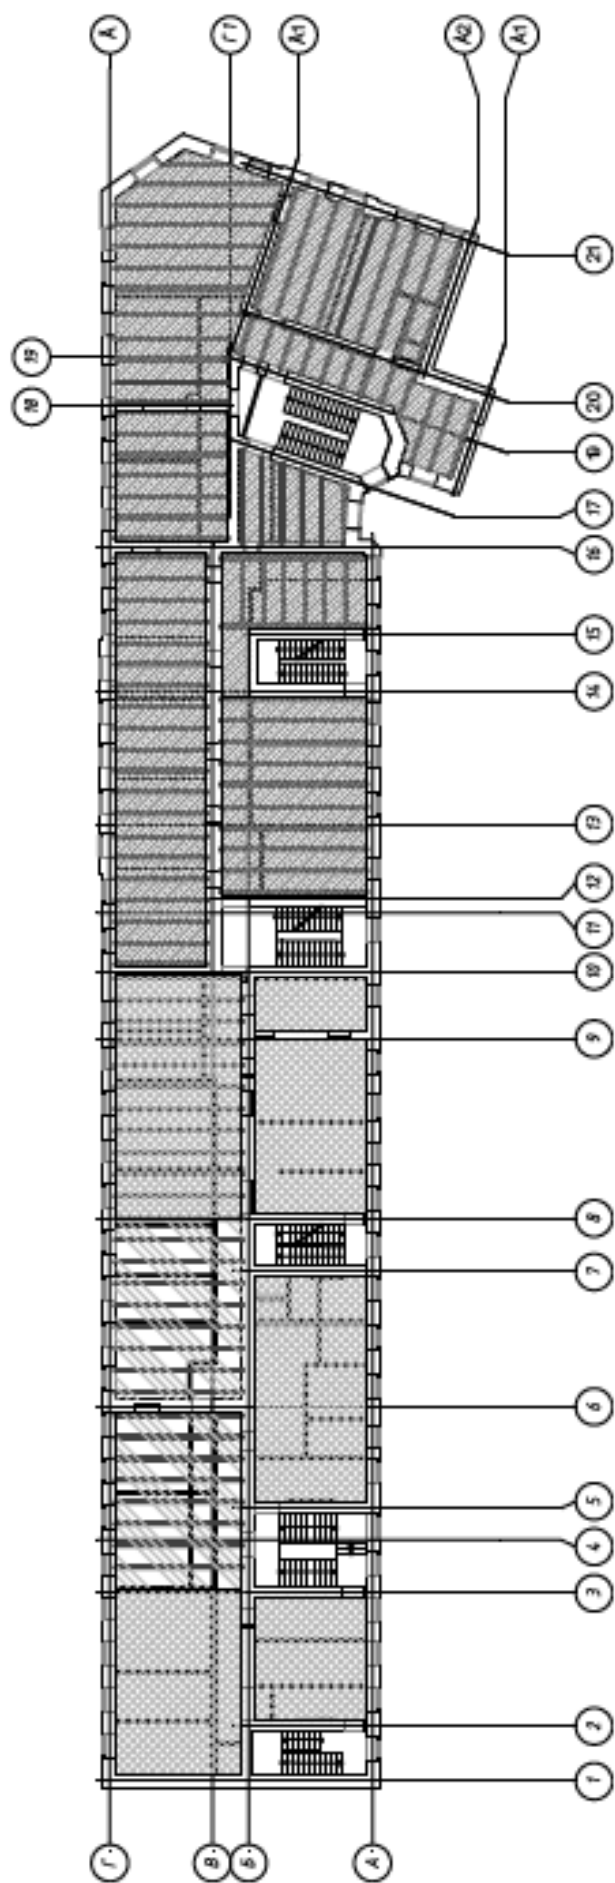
Схема расположения балок 3-го этажа (шаг балок 1000-1200мм)
